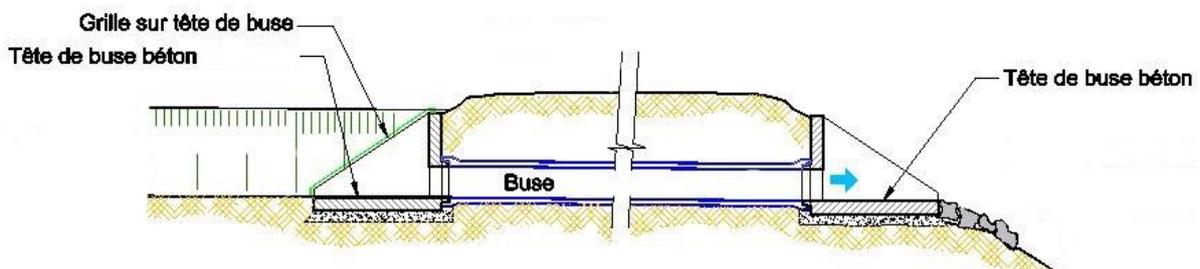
Coupe-type de l'ouvrage de fuite
